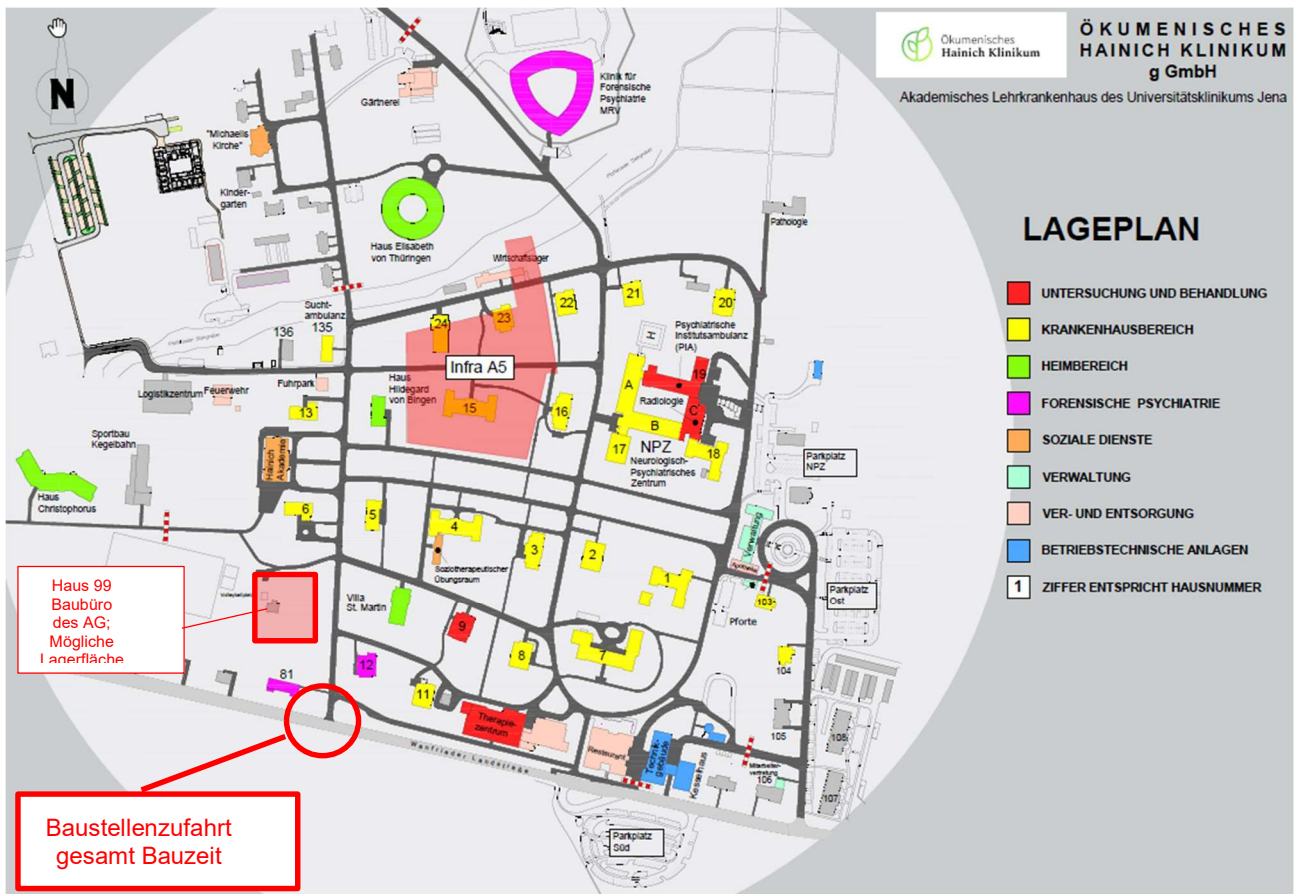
Lageplan ÖHK (Baustellenzufahrt B 249 ÖHK)
